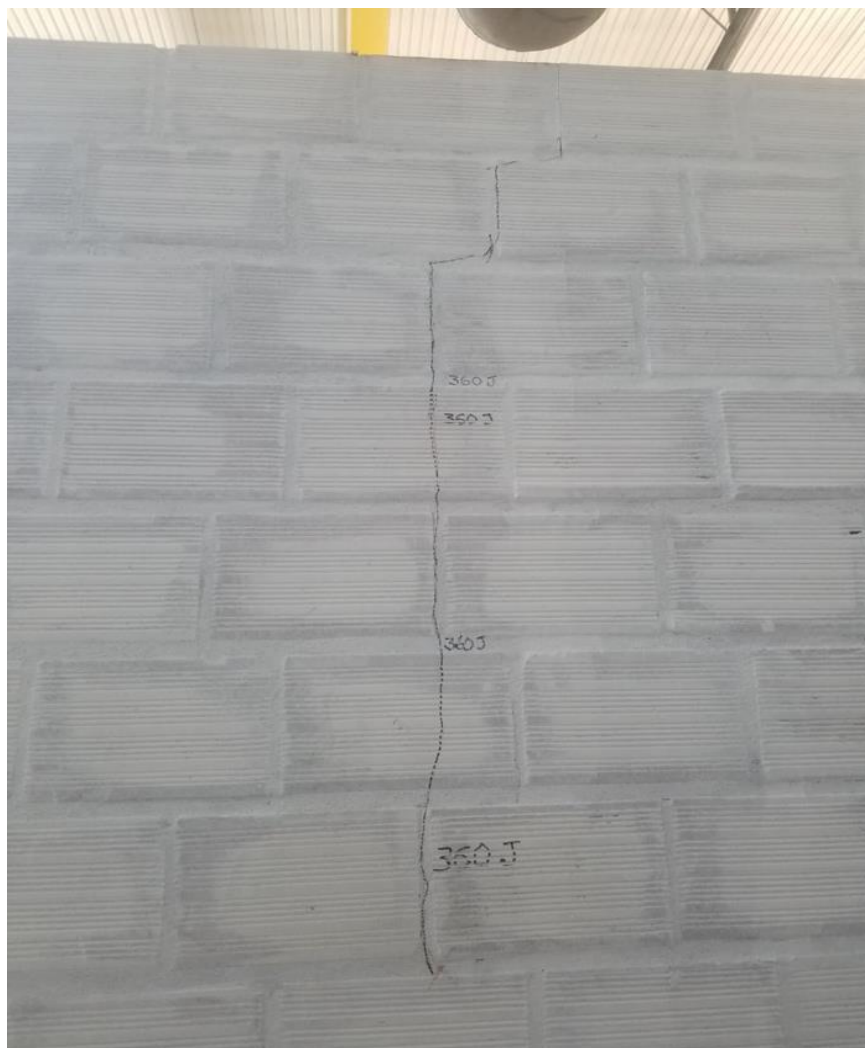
Vista frontal da ALV – 2 com o mapeamento das fissuras
